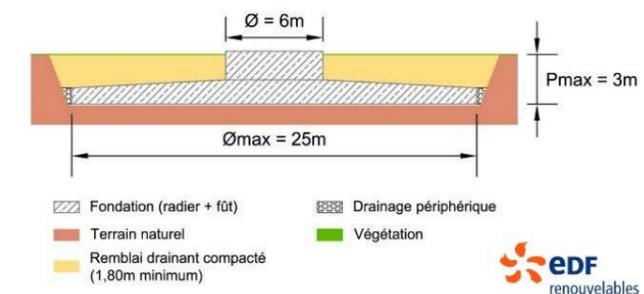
Principe de dimensionnement d'une fondation d'une éolienne
